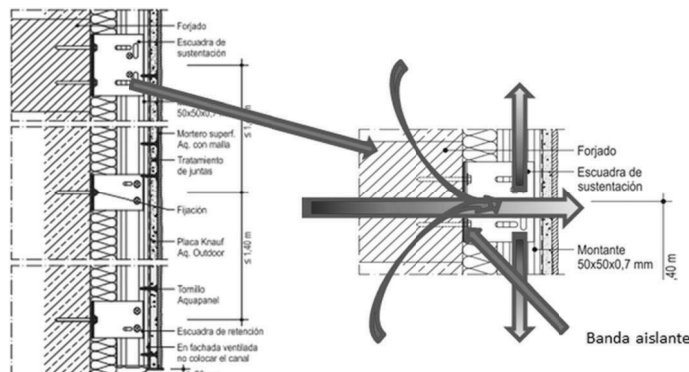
Sistema de rehabilitación de fachada mediante sistema Knauf Aquapanel WL121C.es (fachada no ventilada).
